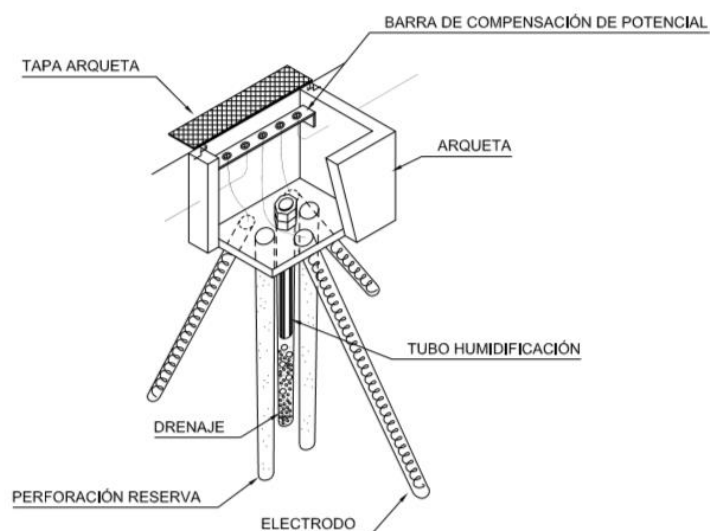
Vista esquemática del dispositivo de puesta a tierra.
